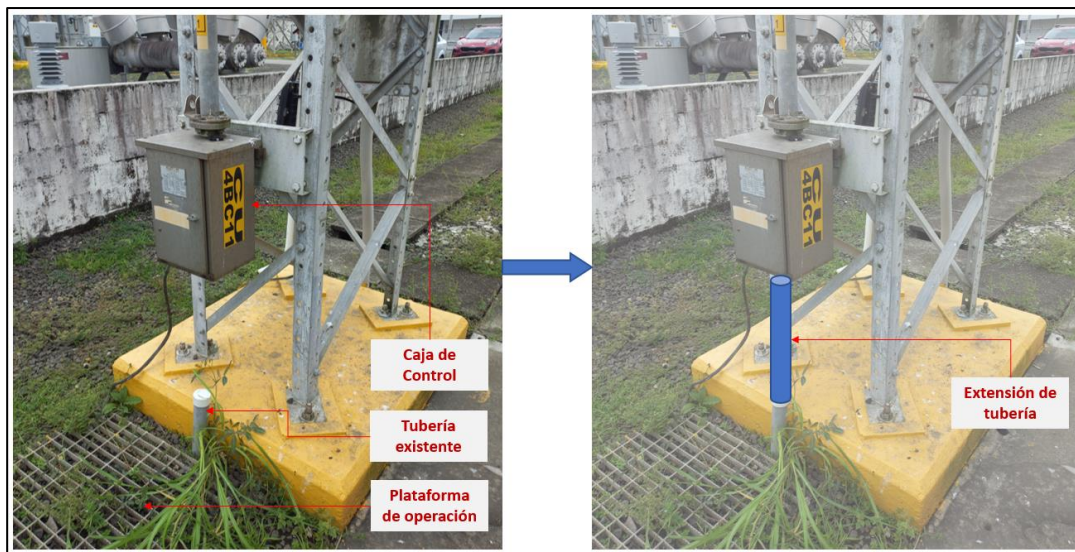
Concepto de instalación de tubería para CU 4BC11
